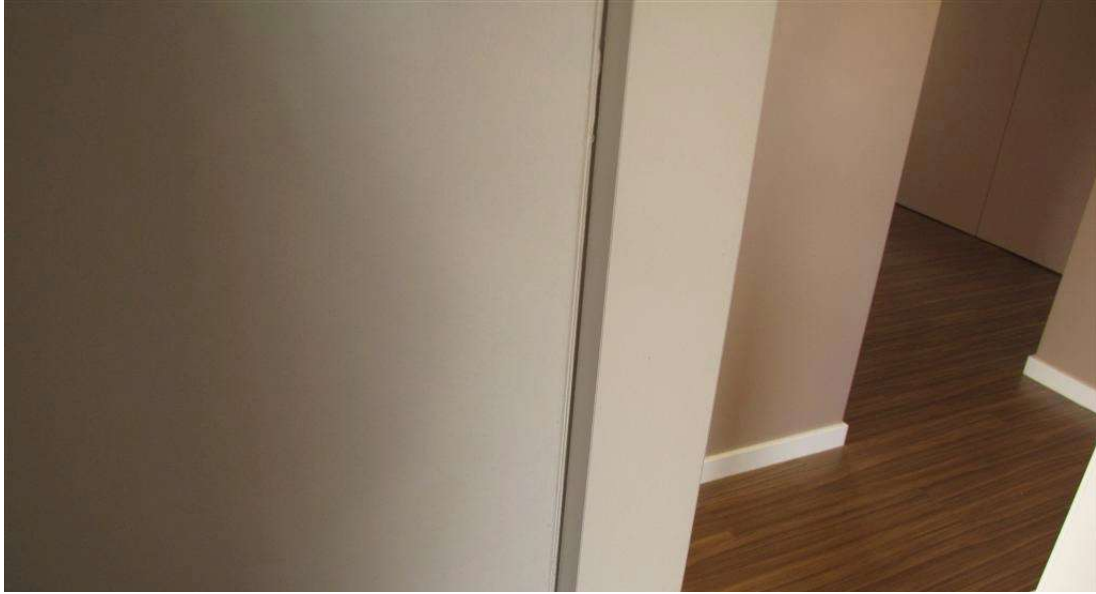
Fissuração da junta entre a parede e o aro da porta na lavandaria
